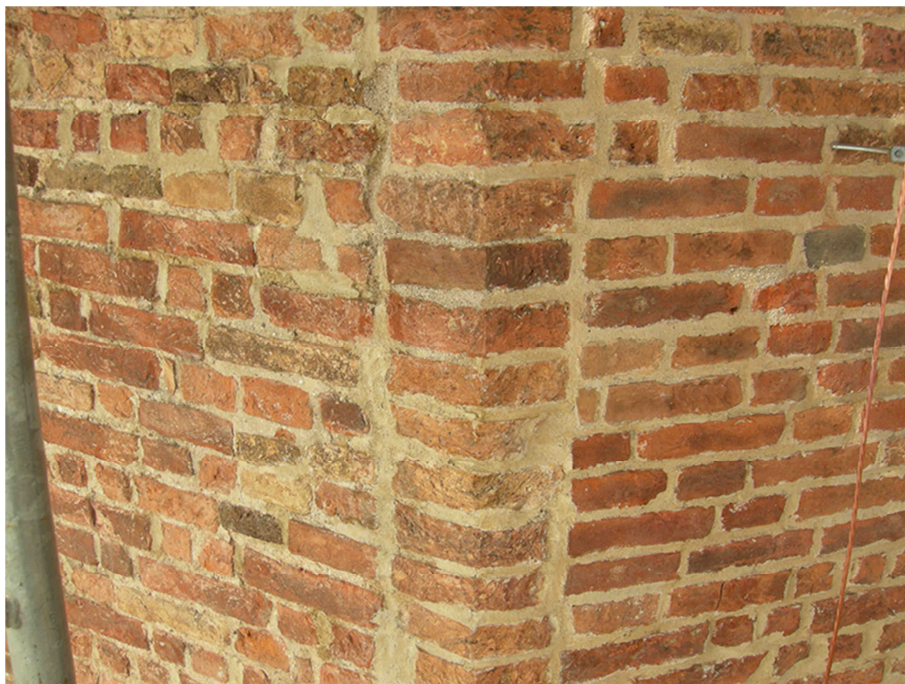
Particolare seconda apertura dall'alto – lato sud.
